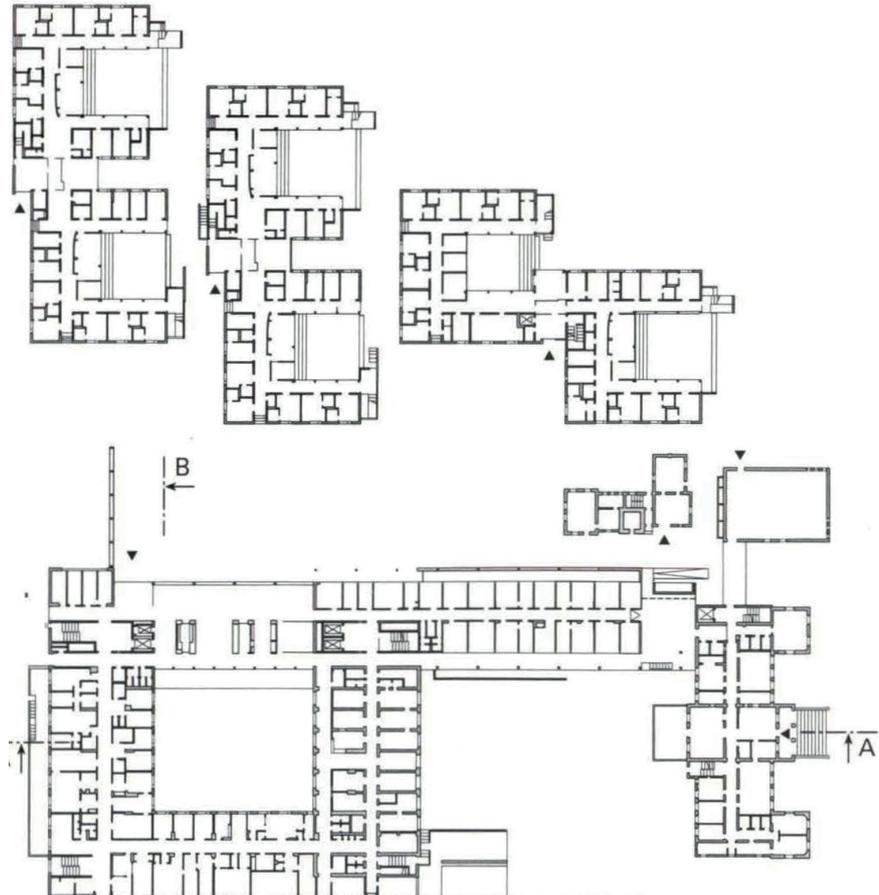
Krankenhaus Hedwigshöhe, Erdgeschoßgrundriss
